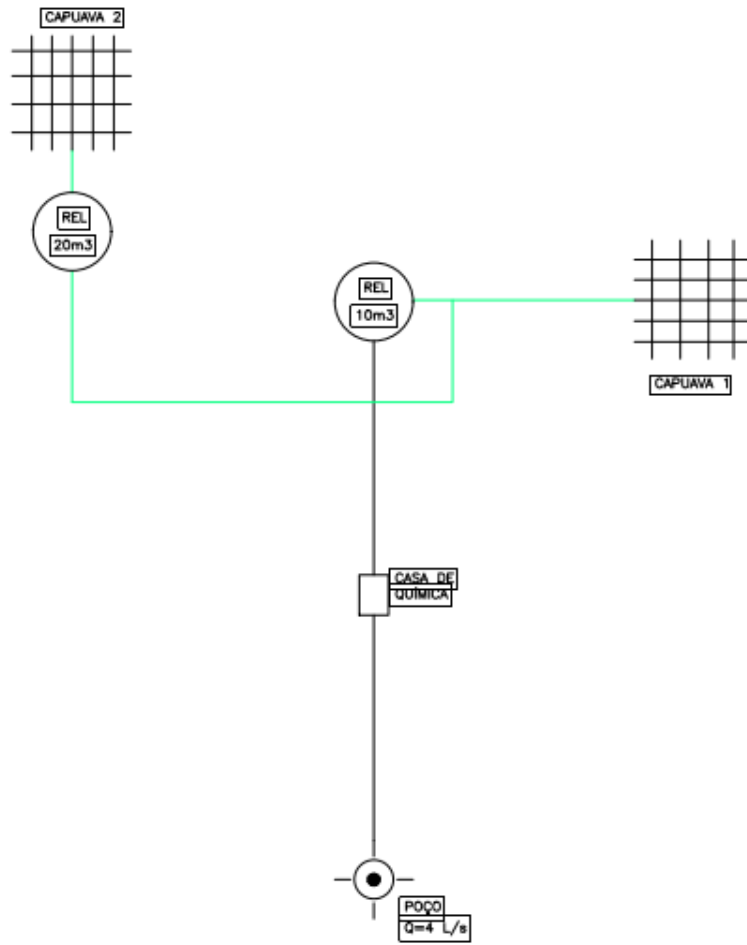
Croqui do Sistema de Abastecimento de Água Existente - Sede
